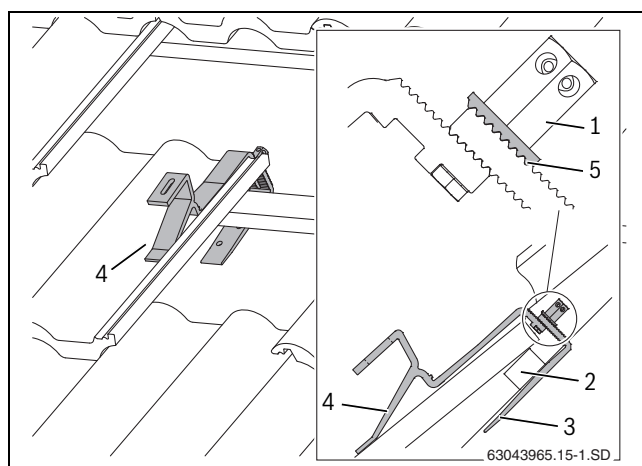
Gancho de tejado enganchado (para facilitar la vista se han eliminado de la figura algunas tejas)
